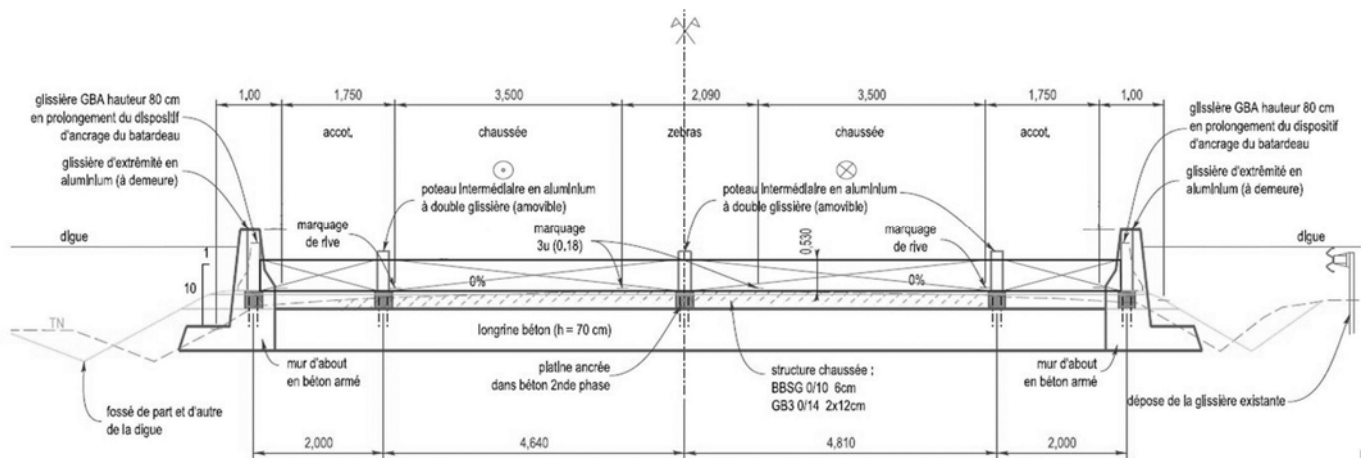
EXEMPLE DE COUPE-TYPE D'UN BATARDEAU AMOVIBLE.
